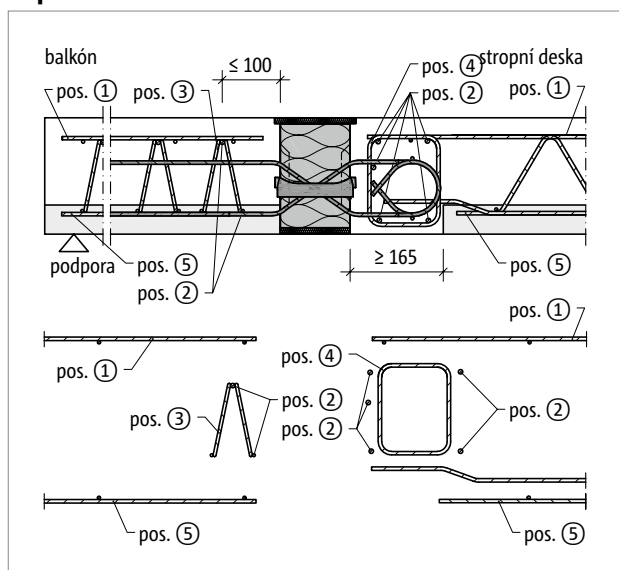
Schöck Isokorb® XT typ QL-VV1 až VV4: Napojovací stavební výztuž v průvlaku
